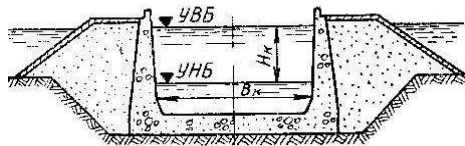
Железобетонная камера шлюза без продольных водопроводных галерей с монолитными стенами и неразрезным дном
